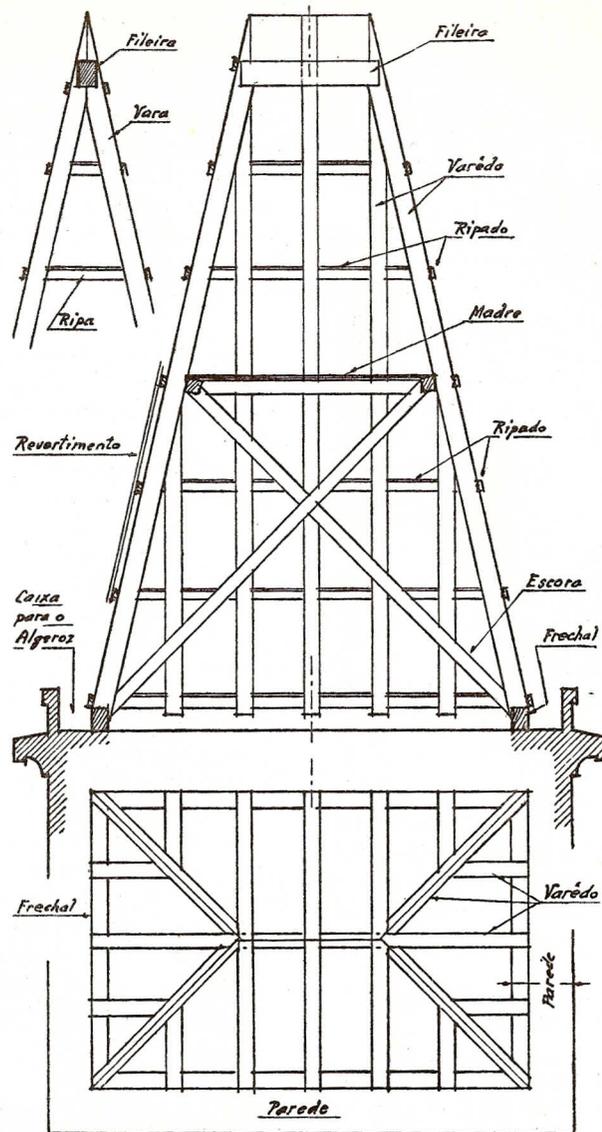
ESTRUTURA DO MADEIRAMENTO DE UM PAVILHÃO DE CRISTA
